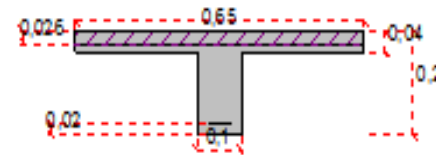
Ferrailage Différents types de poutrelles à étudier en SOCOTEC
